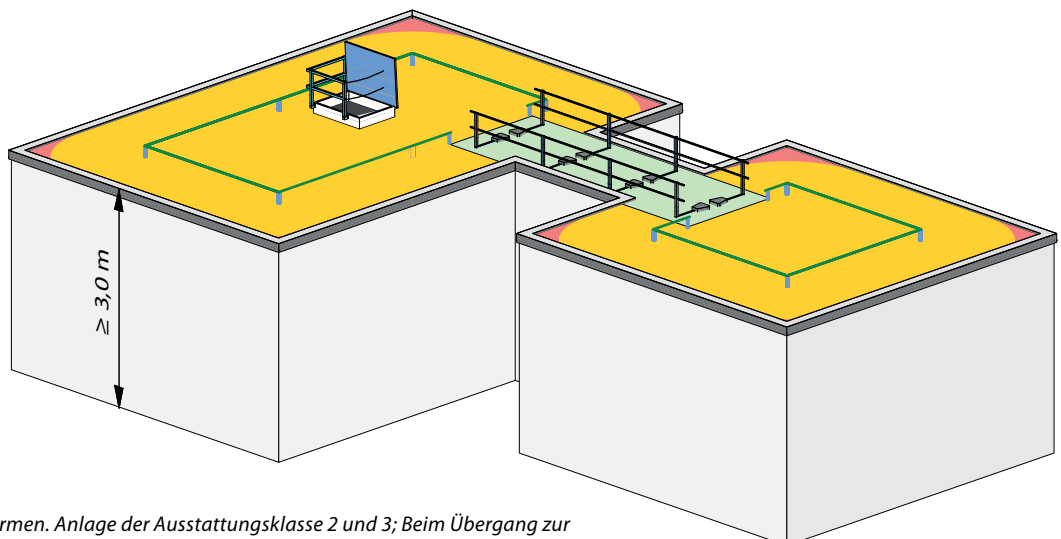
Beispiel spezielle Dachformen. Anlage der Ausstattungsklasse 2 und 3; Beim Übergang zur anderen Dachfläche kann das Seil der Ausstattungsklasse 2 nicht mit einem Abstand von 2,5 m erstellt werden, daher für diesen Bereich auf die Ausstattungsklasse 3 mit Seitenschutz wechseln.
